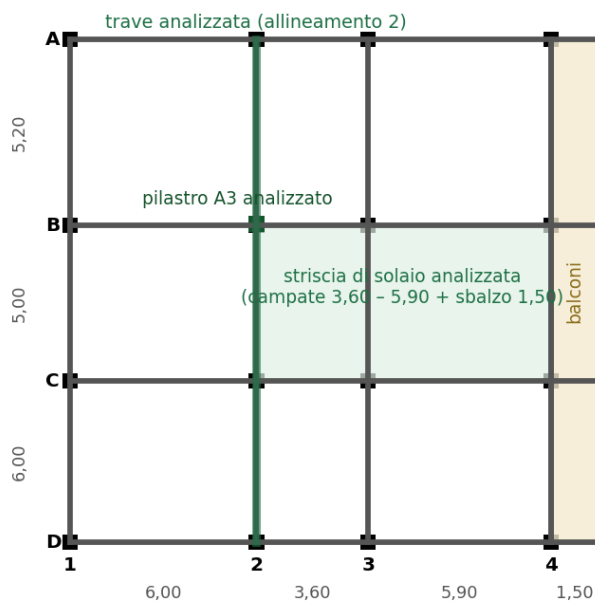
Carpenteria del piano tipo con evidenziati gli elementi analizzati: striscia di solaio, trave dell'allineamento 2 e pilastro A3.
